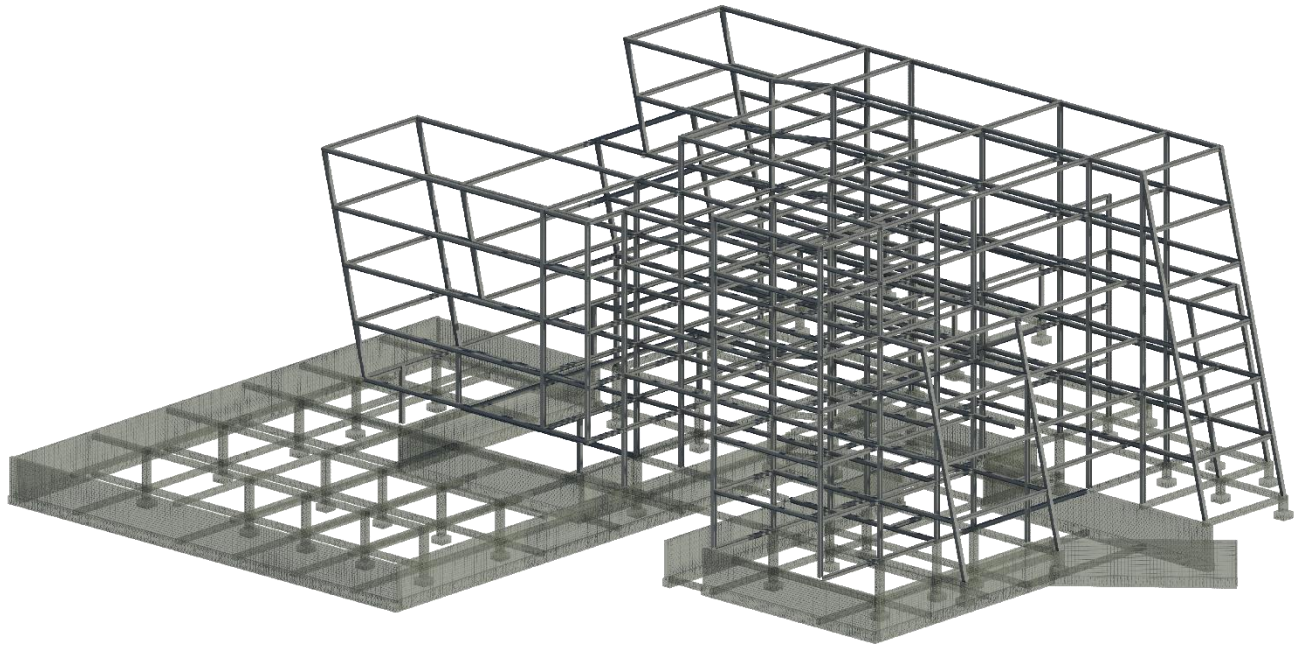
Vista 3d de la estructura del edificio: Tomado de: *autoría propia
